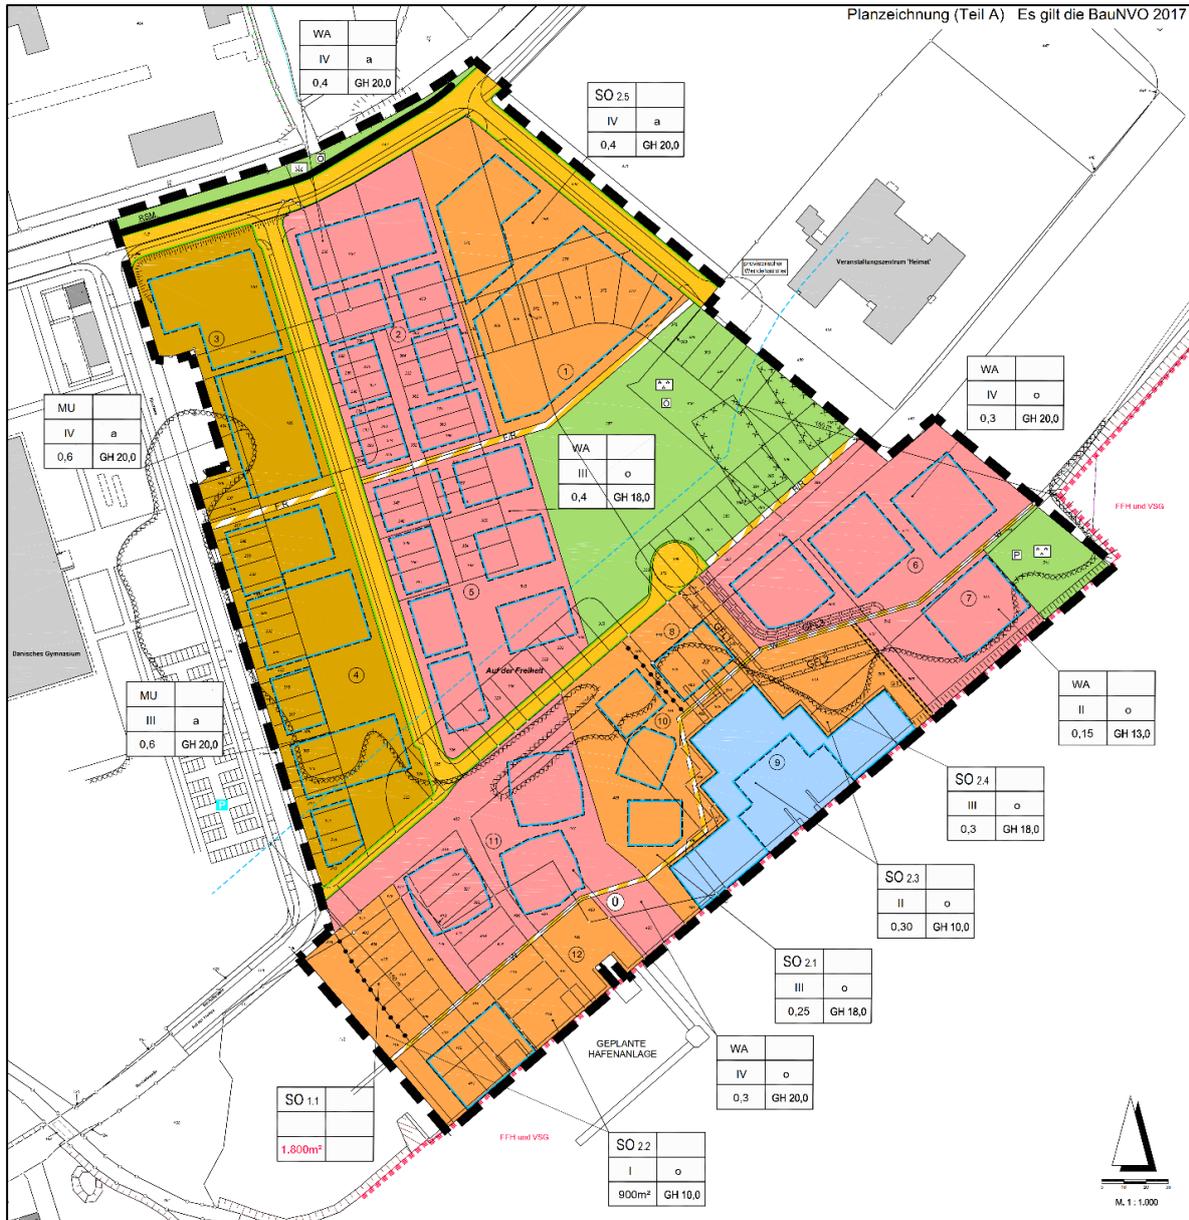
Entwurf des Bebauungsplans, Stand 30.04.2020
